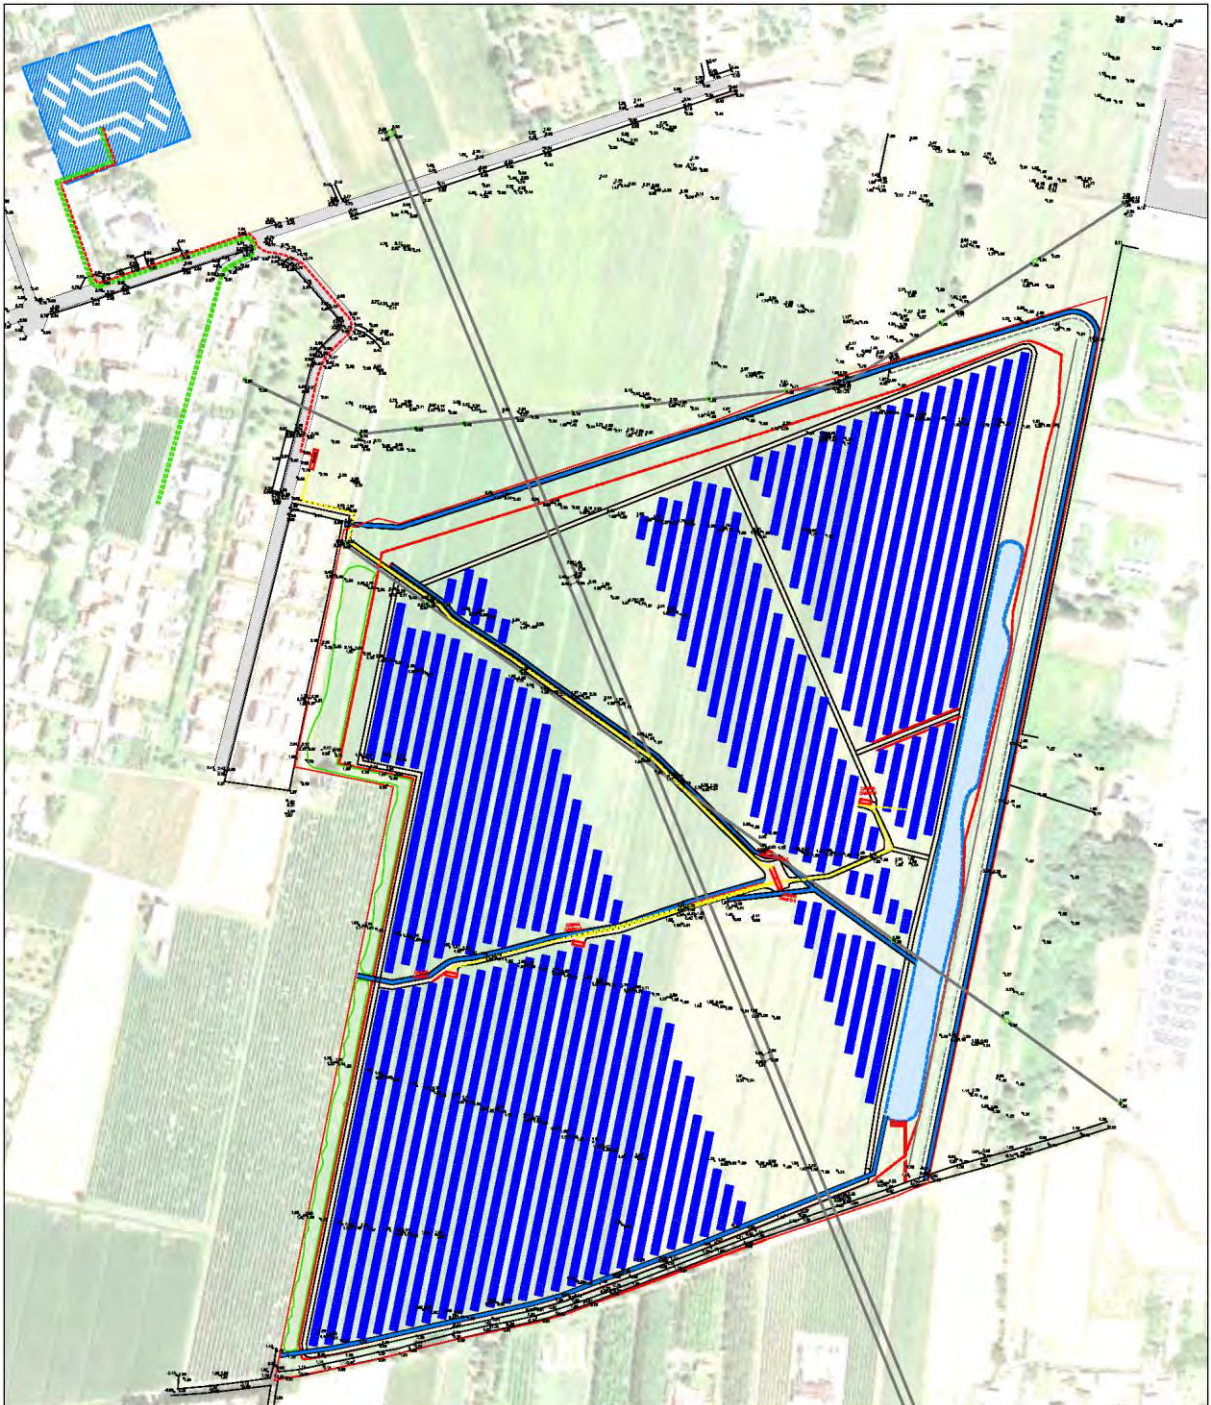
Planimetria di progetto con indicazione dei pannelli e delle principali opere interessate dell'impianto
